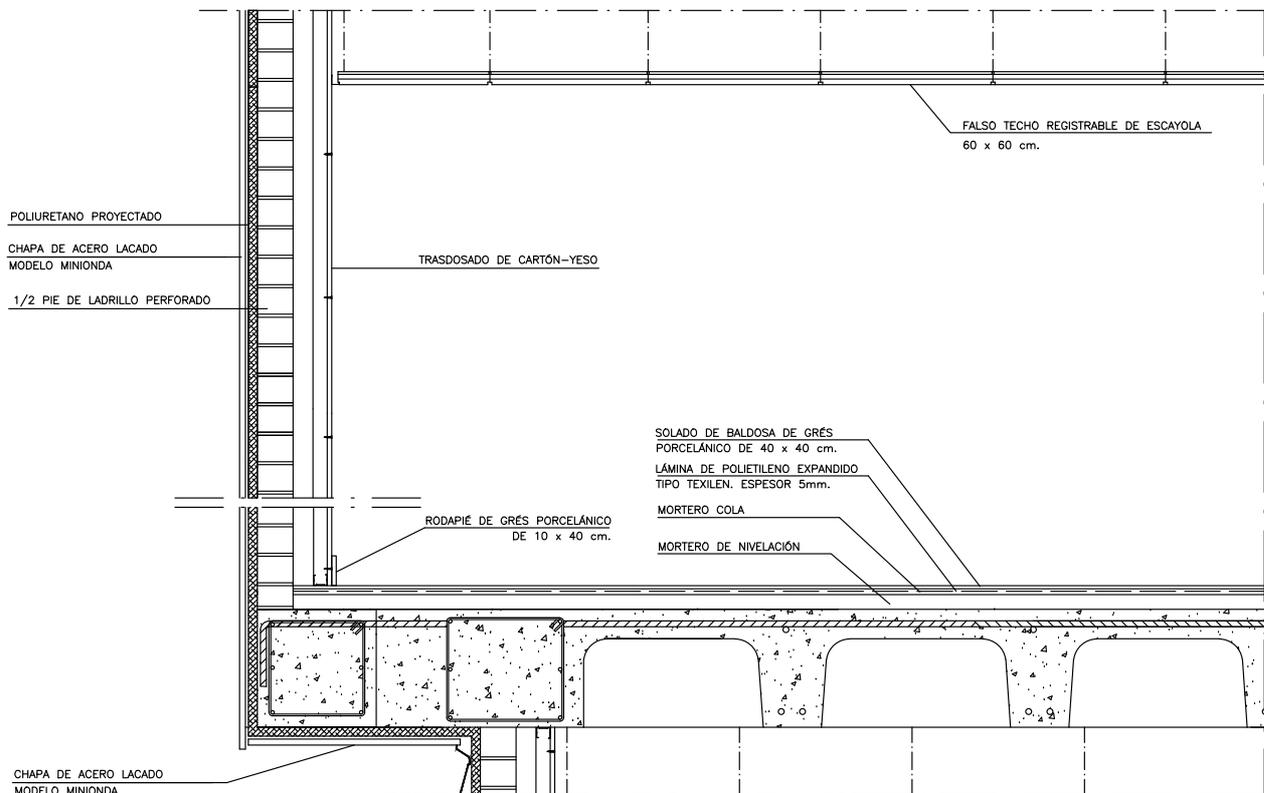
Detalle Sección Vertical hoja interior fachada sur edificio ETSIE.
